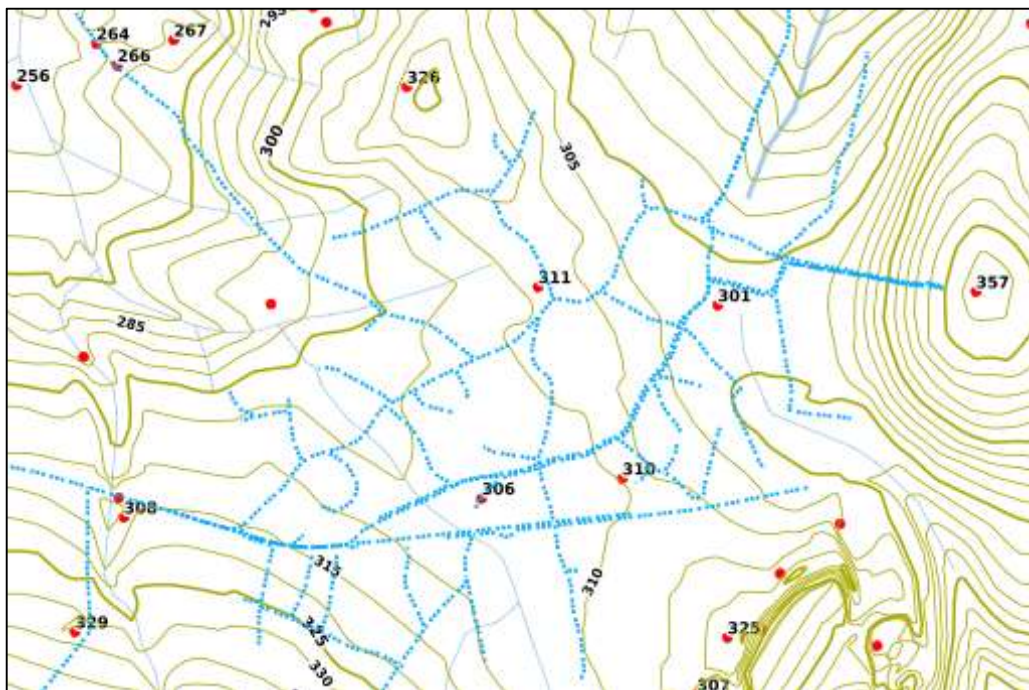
Traçado do subsistema do “Bairro” sobre planta topografica (Câmara Municipal de Ourém, 2018)
